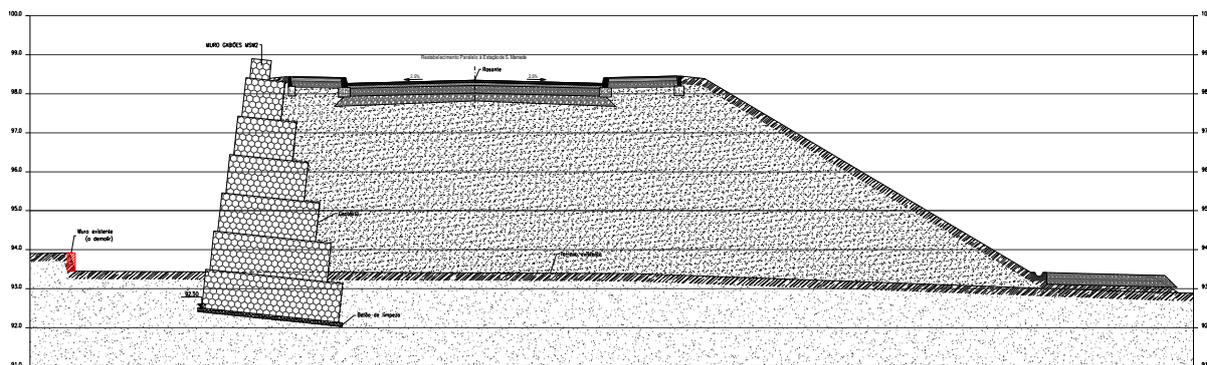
Perfil transversal ao KM 0+294 – MSM2 (Secção 15)
